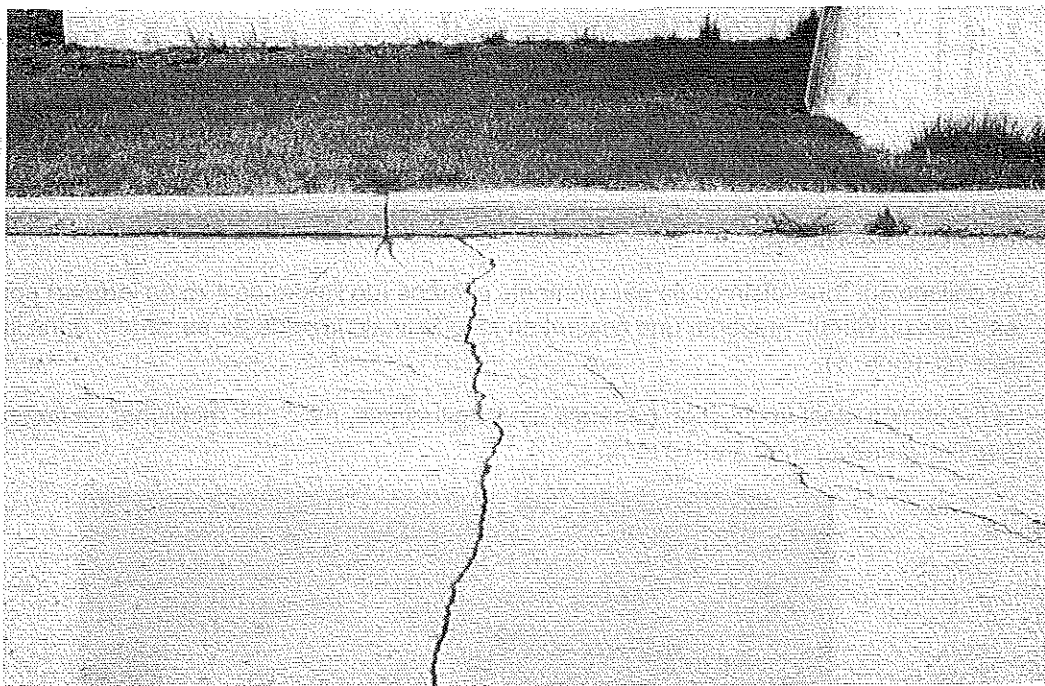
Fissuration transversale (principale) et longitudinale (secondaire) d'un dallage extérieur.
